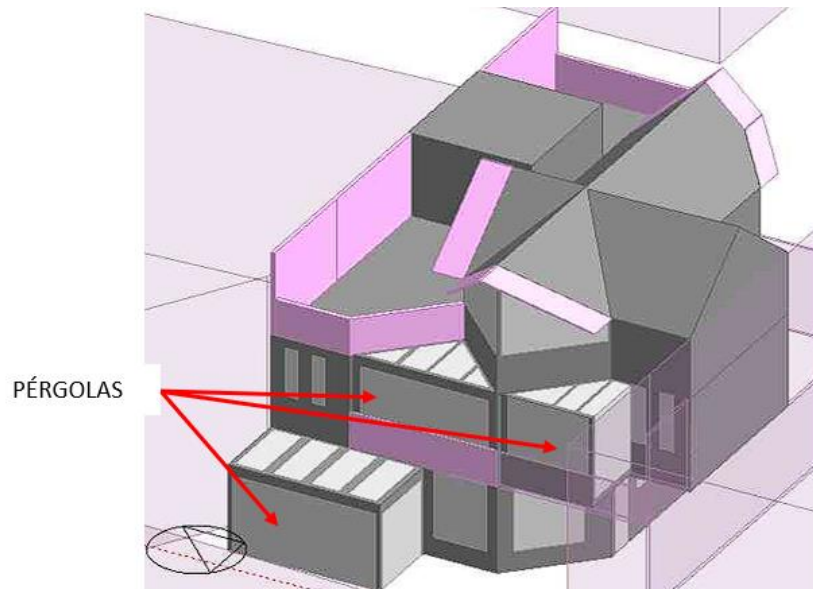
Propuesta de pérgolas tipo invernadero en la fachada Sur.
